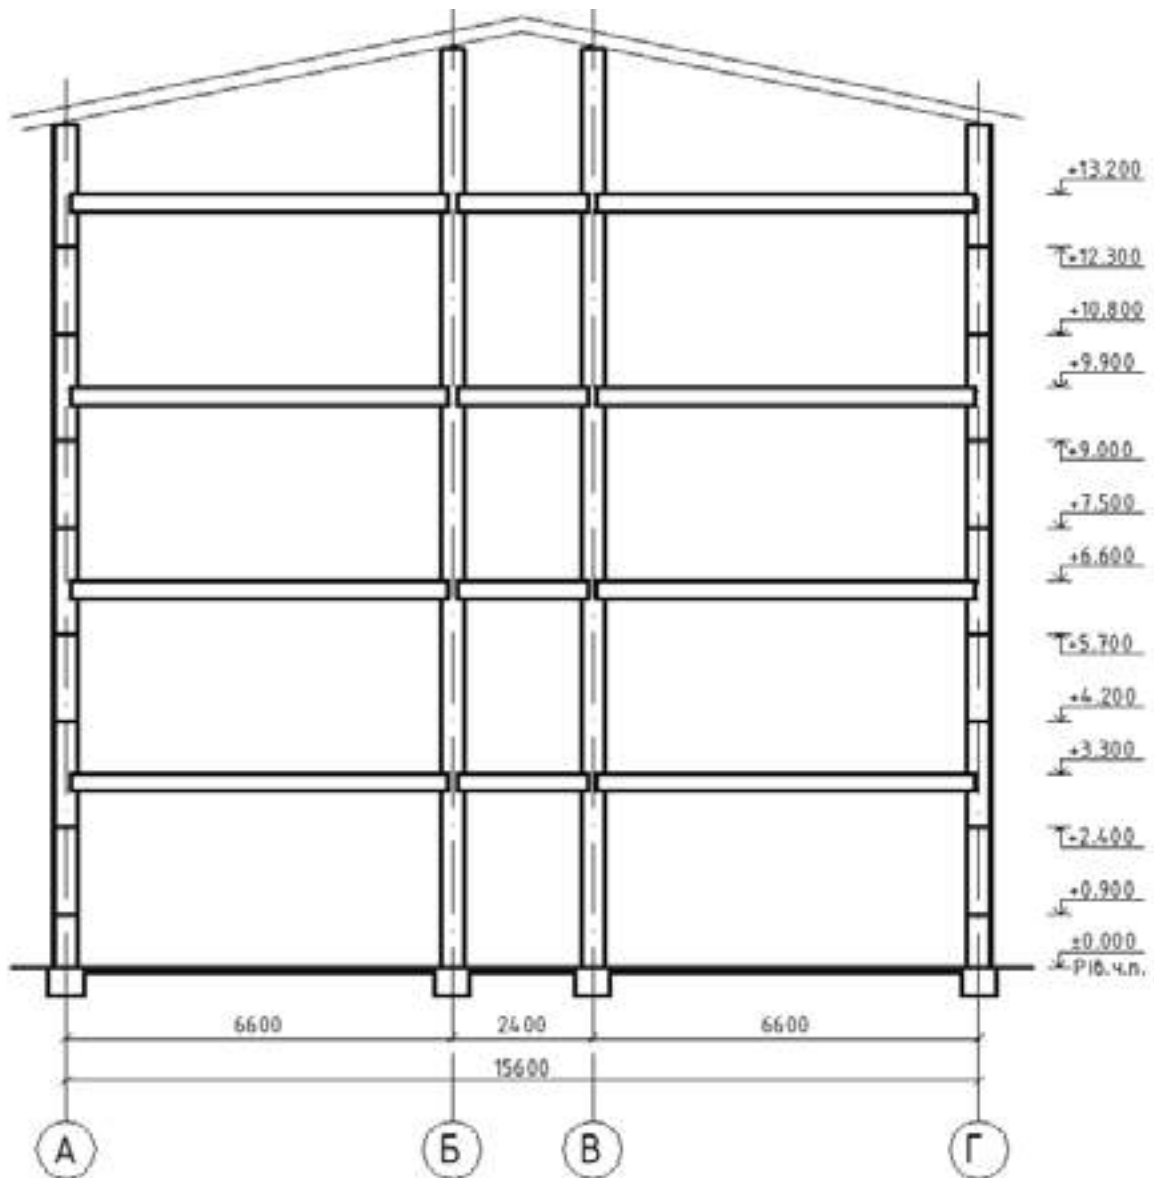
Поперечний розріз 4-поверхового будинку з мансардою
